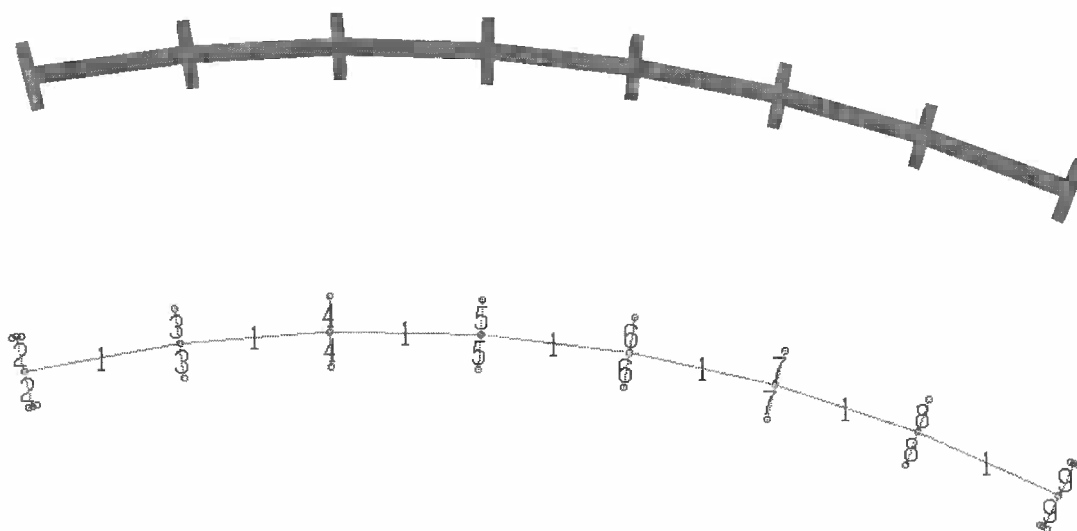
Verifiche alla fessurazione delle travi di collegamento in fondazione, indicazione degli elementi.
